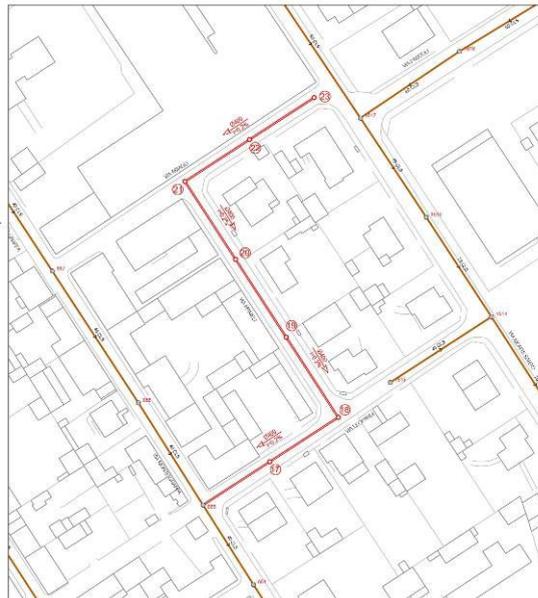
Planimetria di progetto nelle vie Leopardi, Mameli e Asiago
